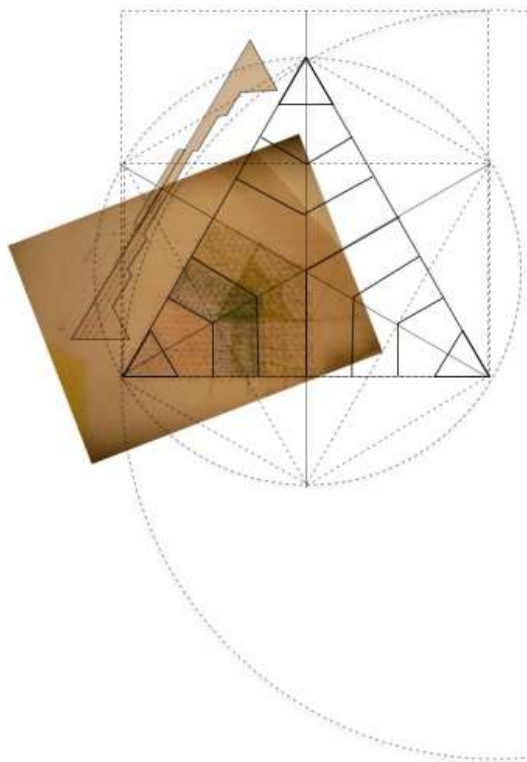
Reconstrucción del autor. Prototipo 2, según estudio de planimetrías de Tyng.
